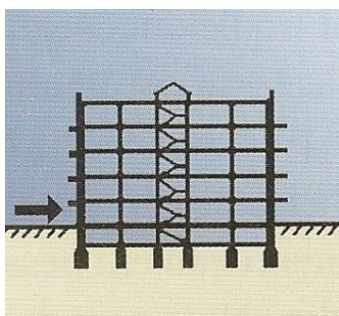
Ilustração do tipo de estrutura de edifícios mistos de alvenaria e betão armado
